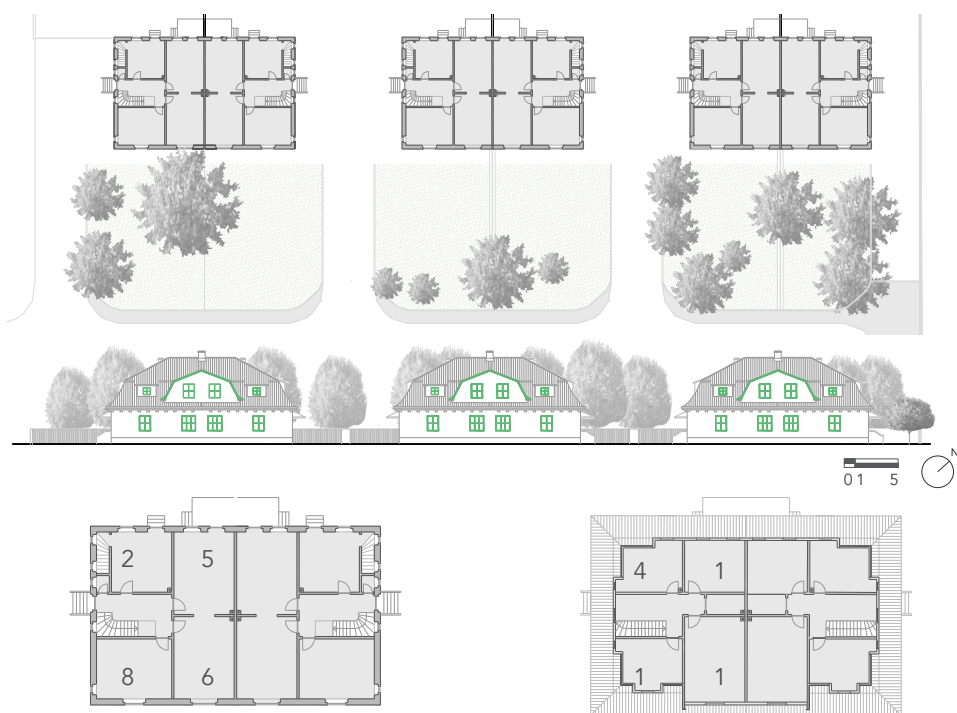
Planta e alçado das casas n.º 1, 2, 3, 4, 5 e 6; Planta do 1º e 2º piso das casas 5 e 6
